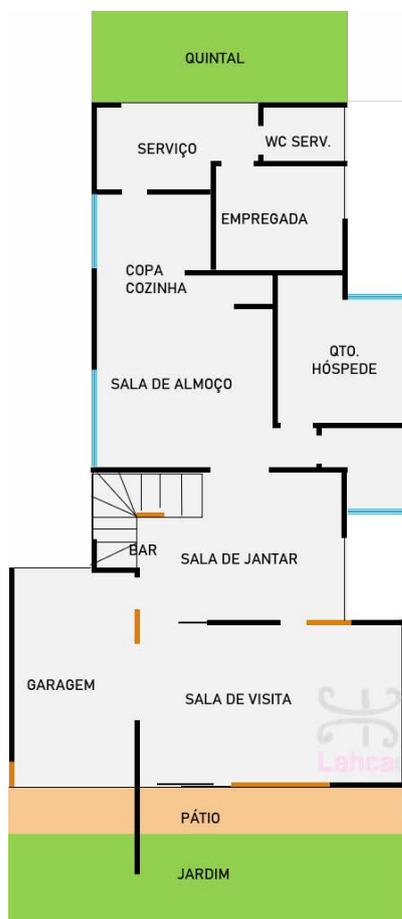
Layout esquemático da Casa Davina Monteiro
